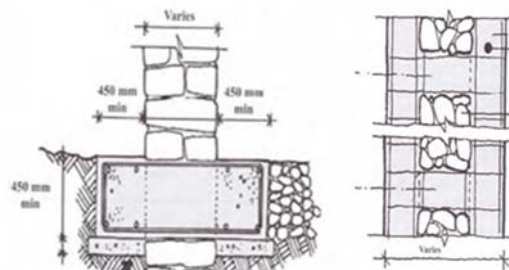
Recalce de una zapata corrida bajo muro de mampostería [7]
